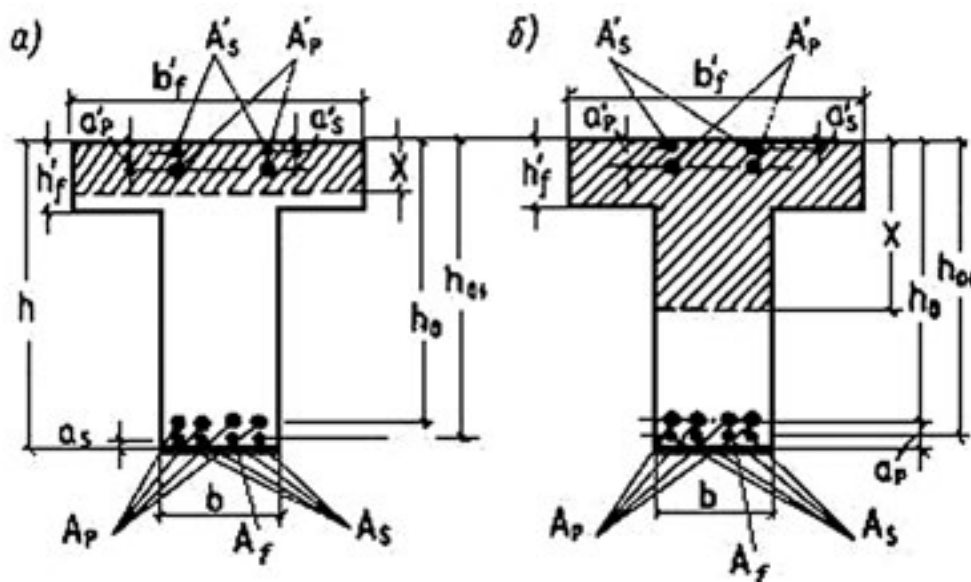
Форма сжатой зоны в сечениях железобетонных элементов с плитой в сжатой зоне
